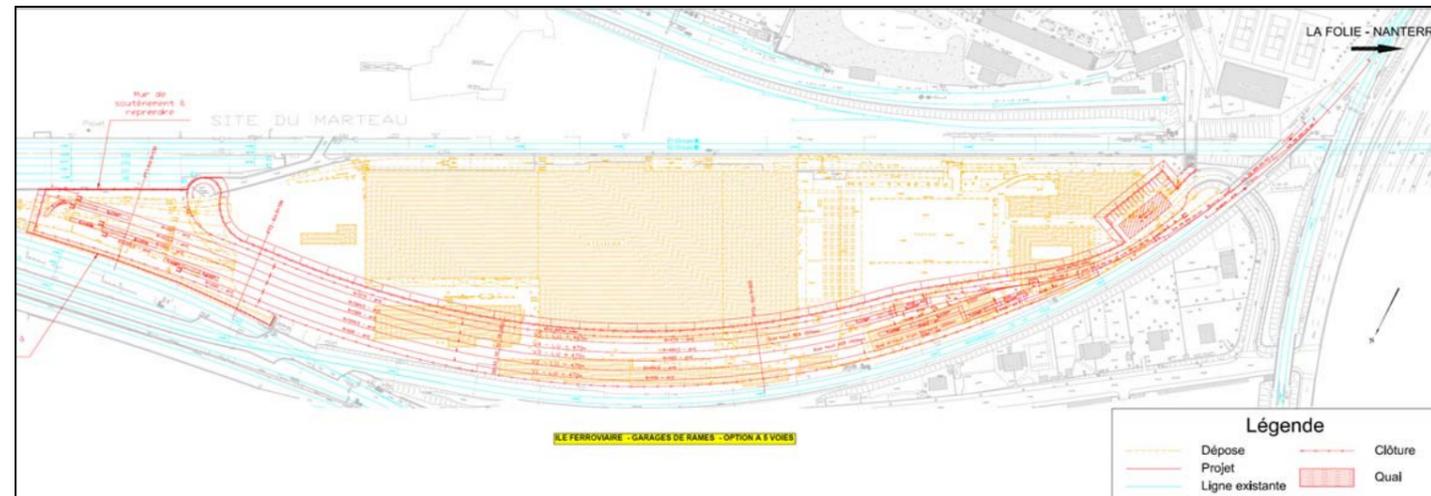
en plan de l'aménagement de l'île ferroviaire, solution comprenant 5 voies de garage
